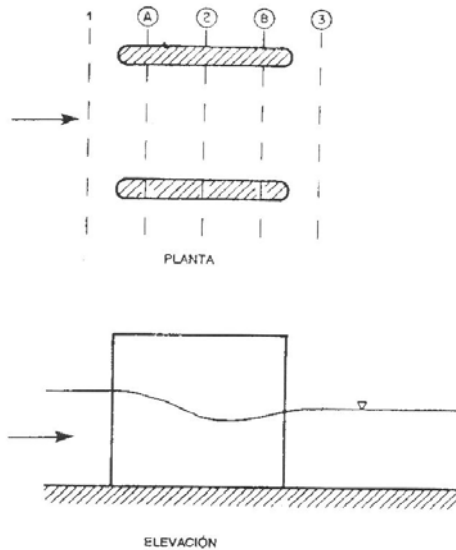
Planta y perfil del flujo a través de pilas de puentes
